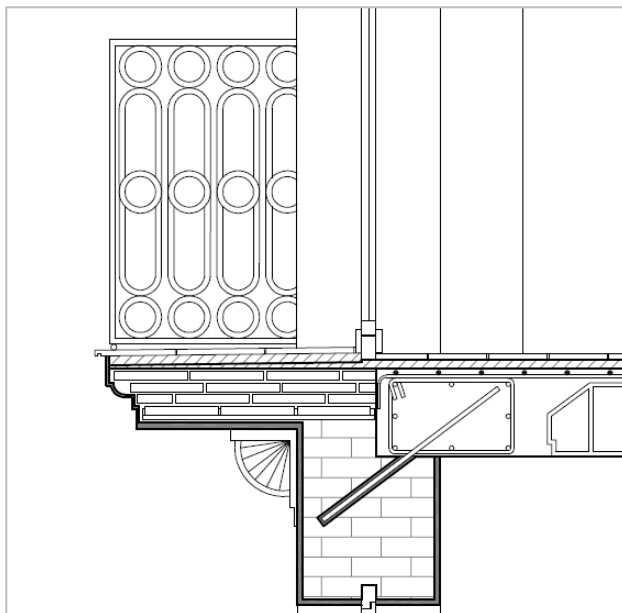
Detalle de la conexión de forjados a muro fachada conservado. En este caso el detalle se ha elaborado a partir de la información gráfica proporcionada en formato papel, adecuando el detalle del balcón no definido. Sin embargo, el resto de detalles que pueden verse en el anexo de documentación gráfica se han creado a partir de los alzados y la distribución que se nos ha proporcionado. Incluso se ha ampliado la definición de los alzados para definir correctamente el valor de la fachada.
